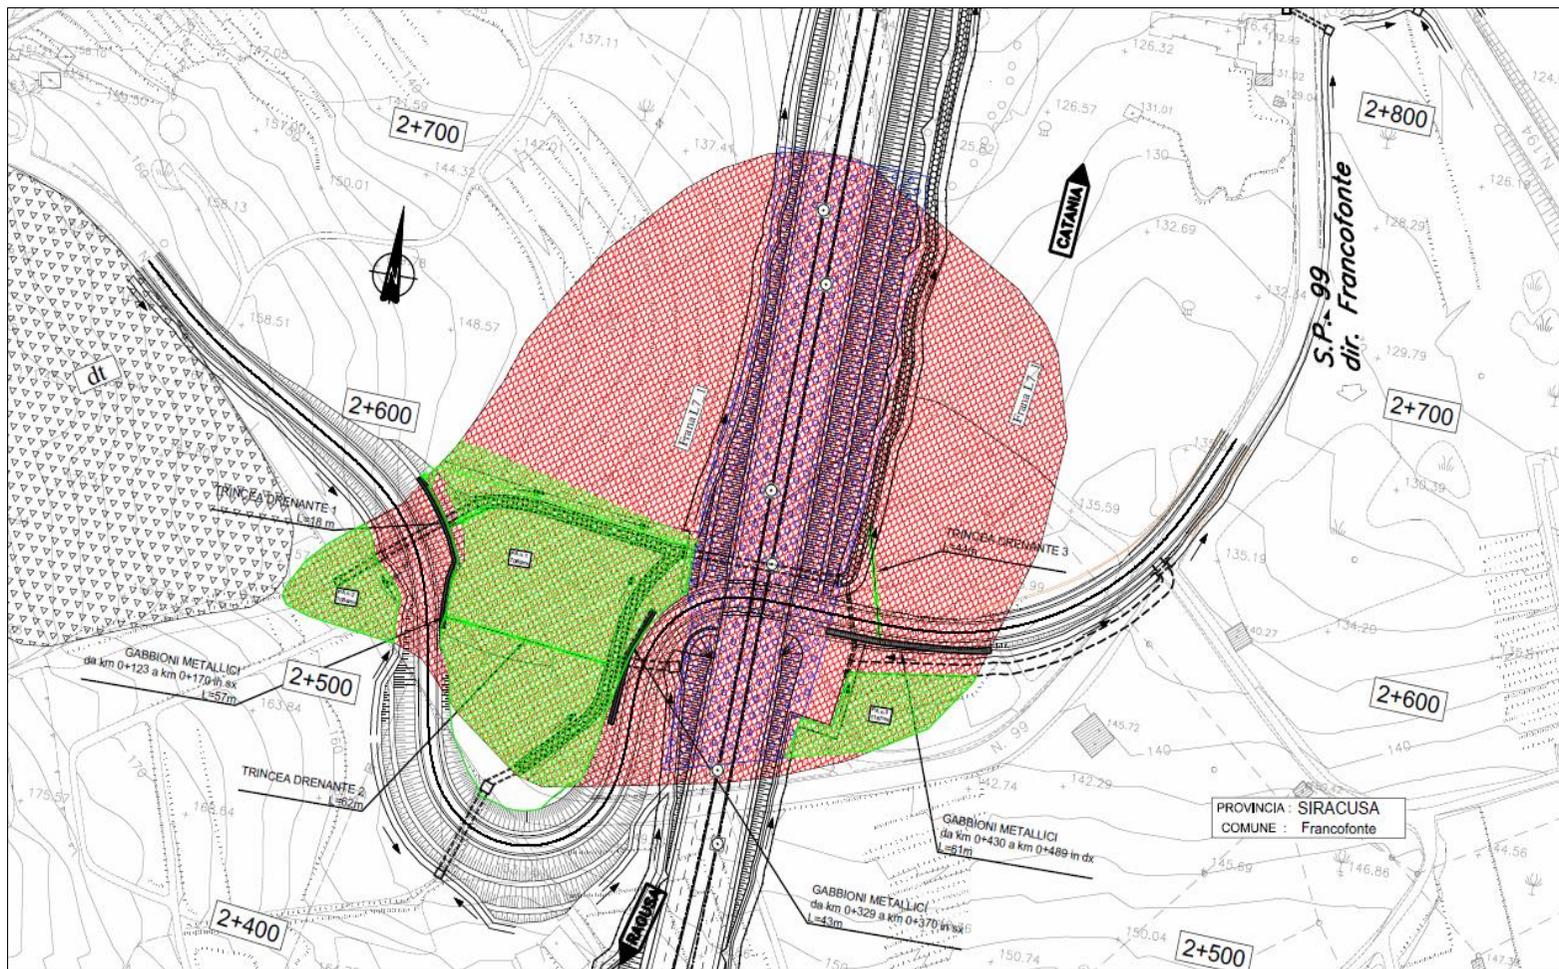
Lotto 7 – Stralcio planimetrico dell'intervento di stabilizzazione
